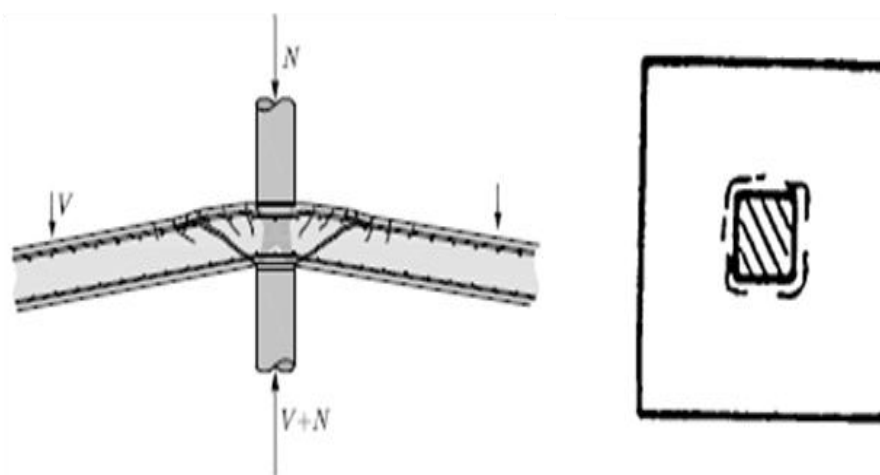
Rupture par poinçonnement d'une dalle en béton armé
